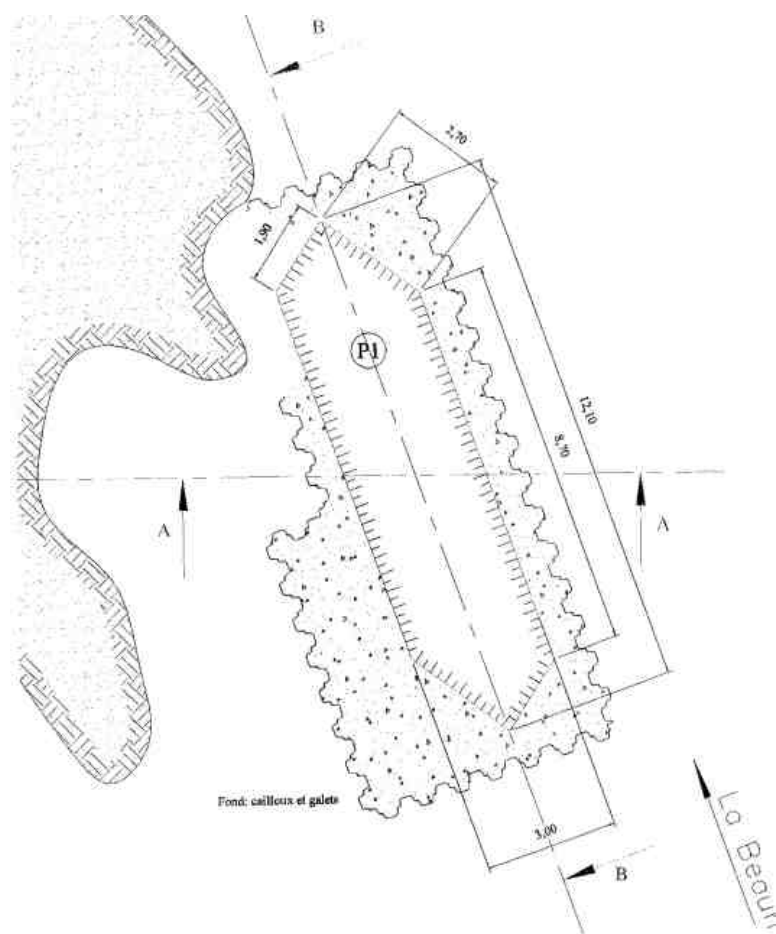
Vue en plan pile n°1 (CG, 2008)
